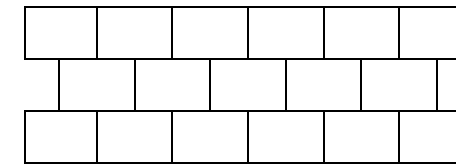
MOSAICO BALDOSAS PL. BAJA
